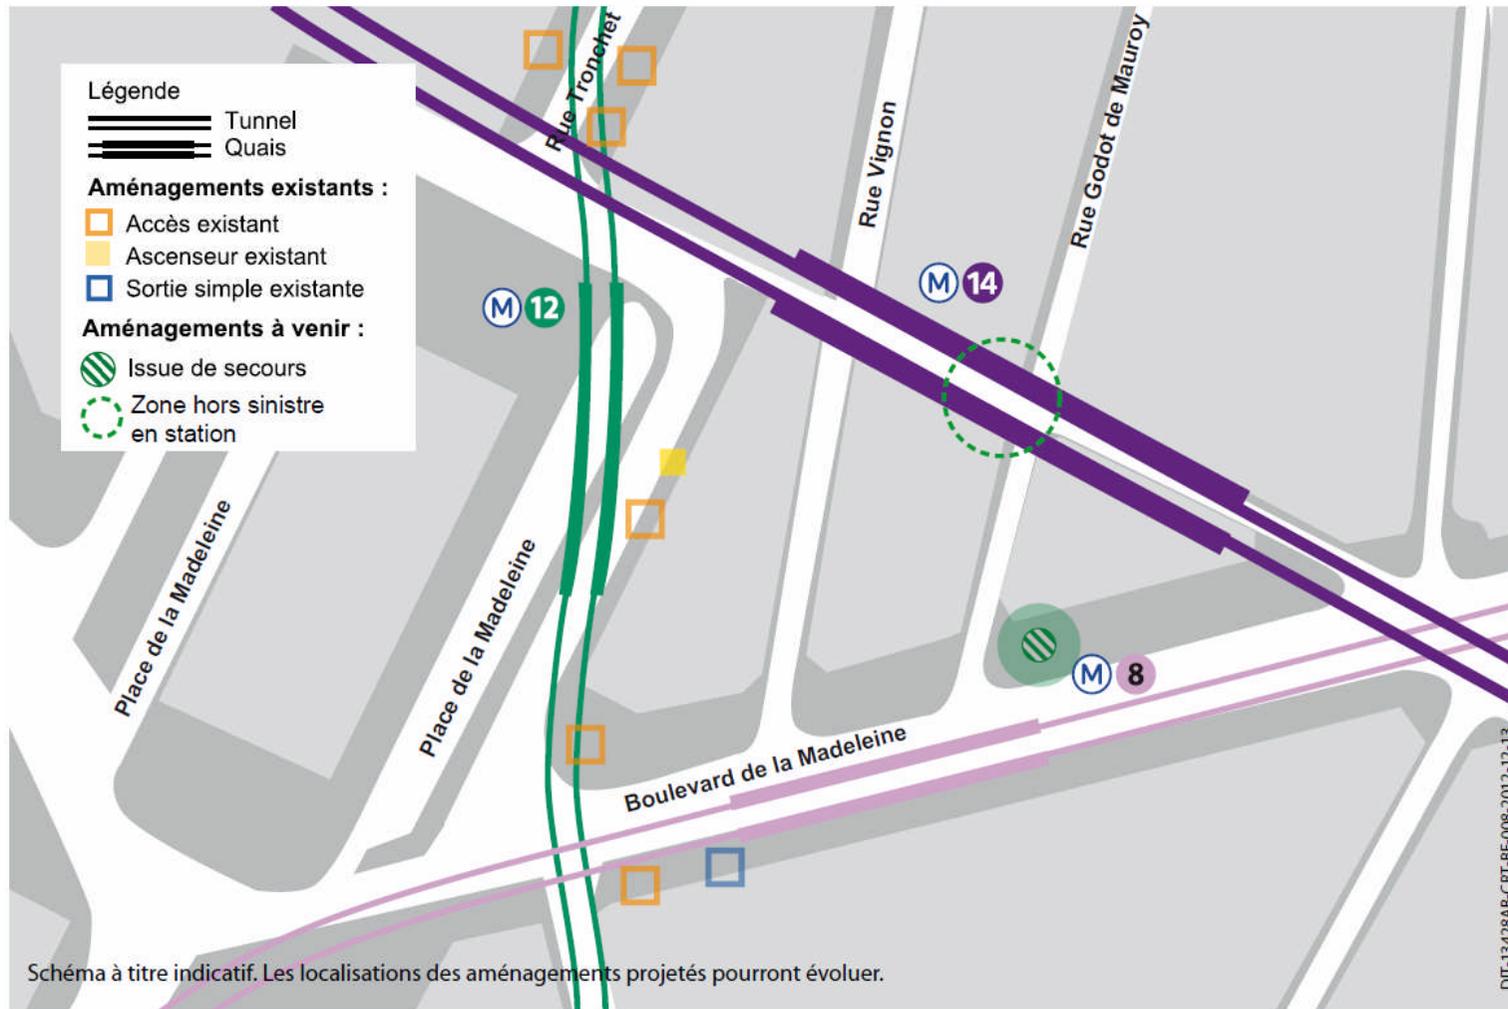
Plan du projet aux abords de la station Madeleine (Source : RATP)
